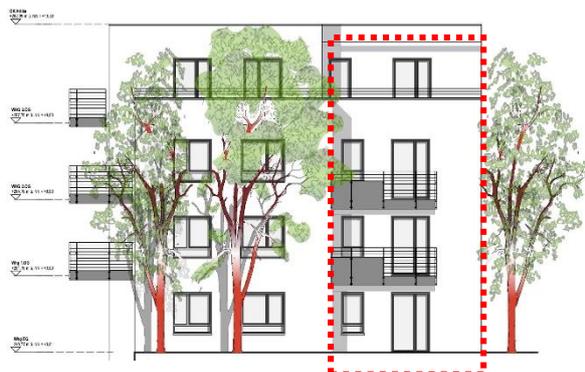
Entwicklung der Baumfassade nach 15-20 Jahren (Florian Köhl, Divya Pilla)
